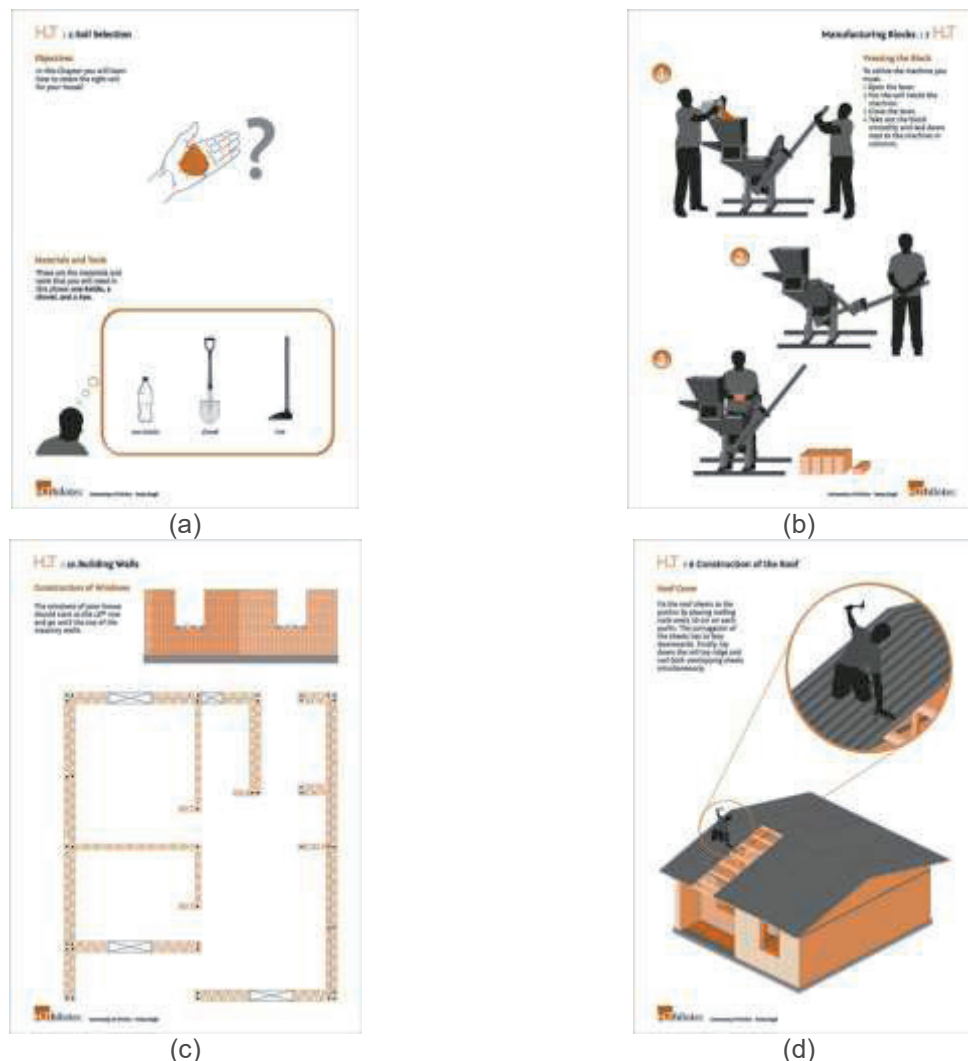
(a) capítulo seleção do solo; (b); capítulo produção dos blocos (c) capítulo construção das janelas; e (d) capítulo construção da cobertura.
